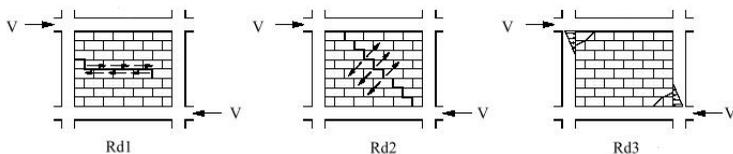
Mecanismele de cedare în plan ale panourilor de umplură la structurile în cadre conform Codului CR6-2006
